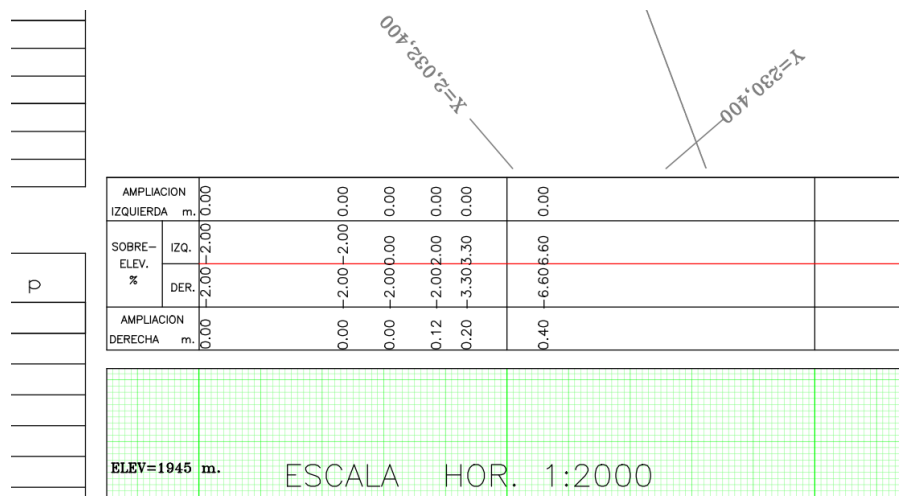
Tirilla de Ampliaciones y Sobreelevaciones en la Planta de Kilometro
